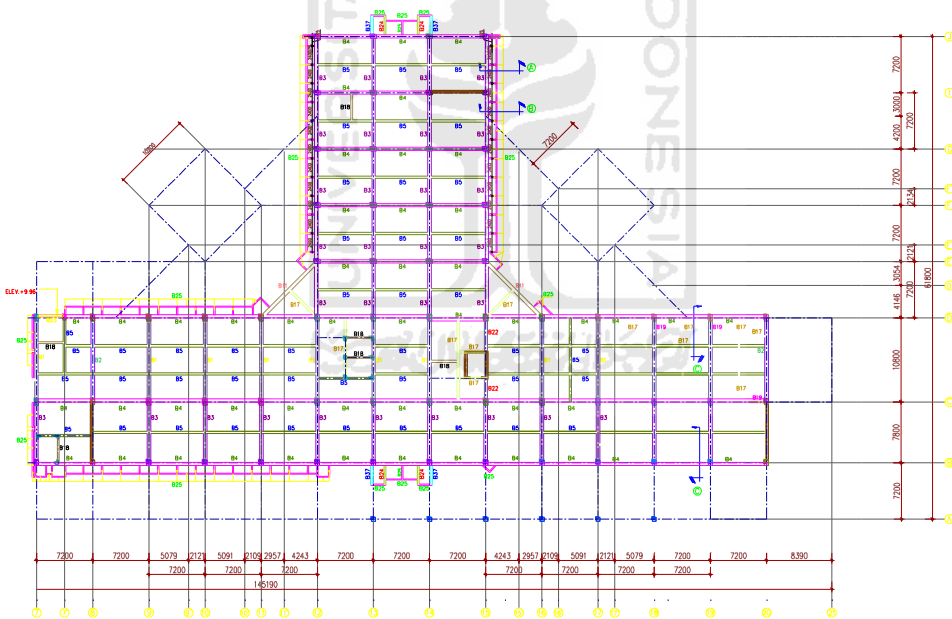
Denah Balok Gedung RSA UII Lantai 1
